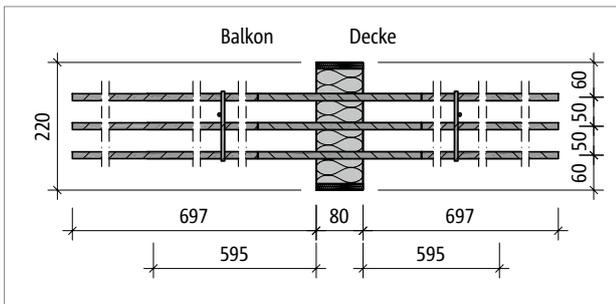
Schöck Isokorb® T Typ B: Produktgrundriss
